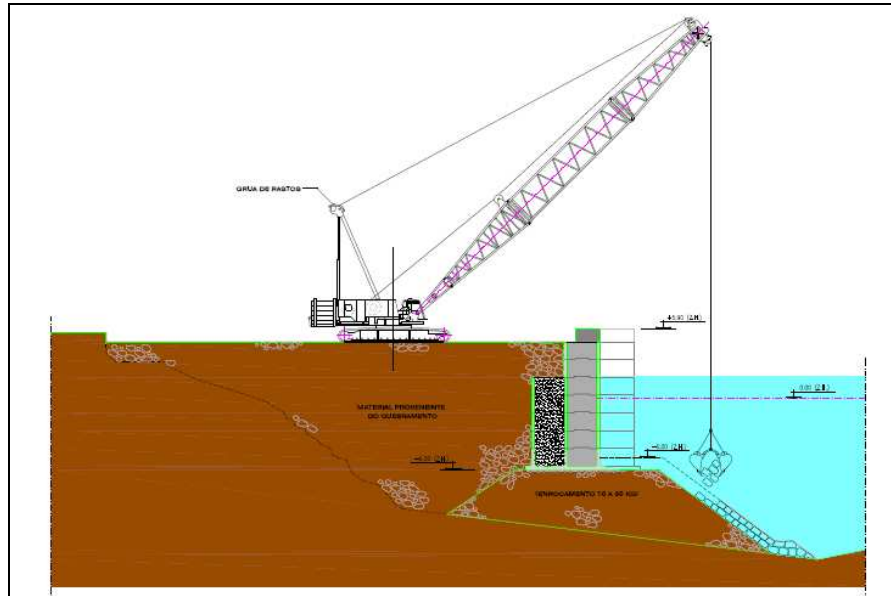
Esquema de execução da protecção do prisma de fundação das aduelas. [25]
